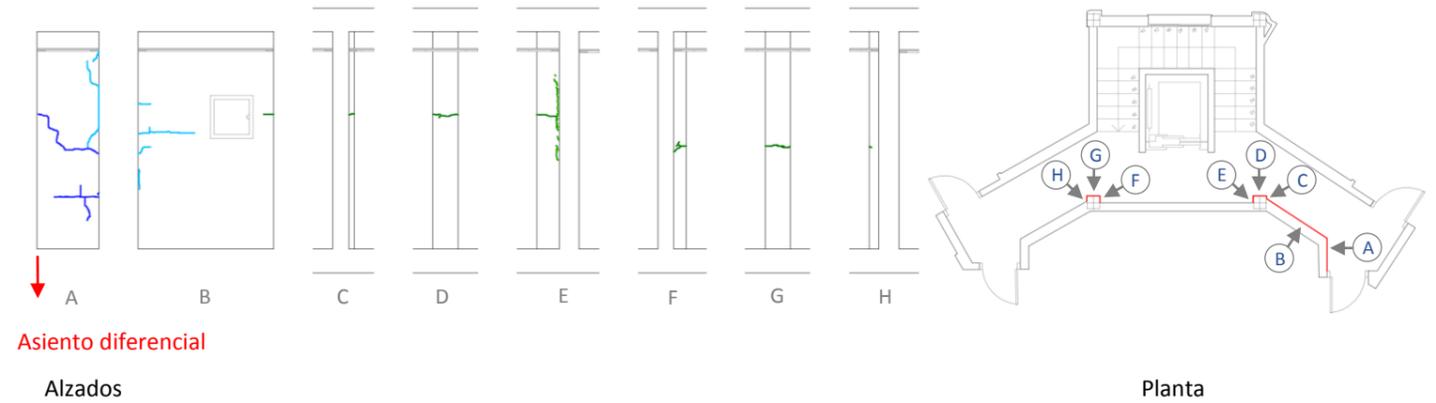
Fisuras grandes/ grietas pasillo planta primera. 2018. Elaboración propia
